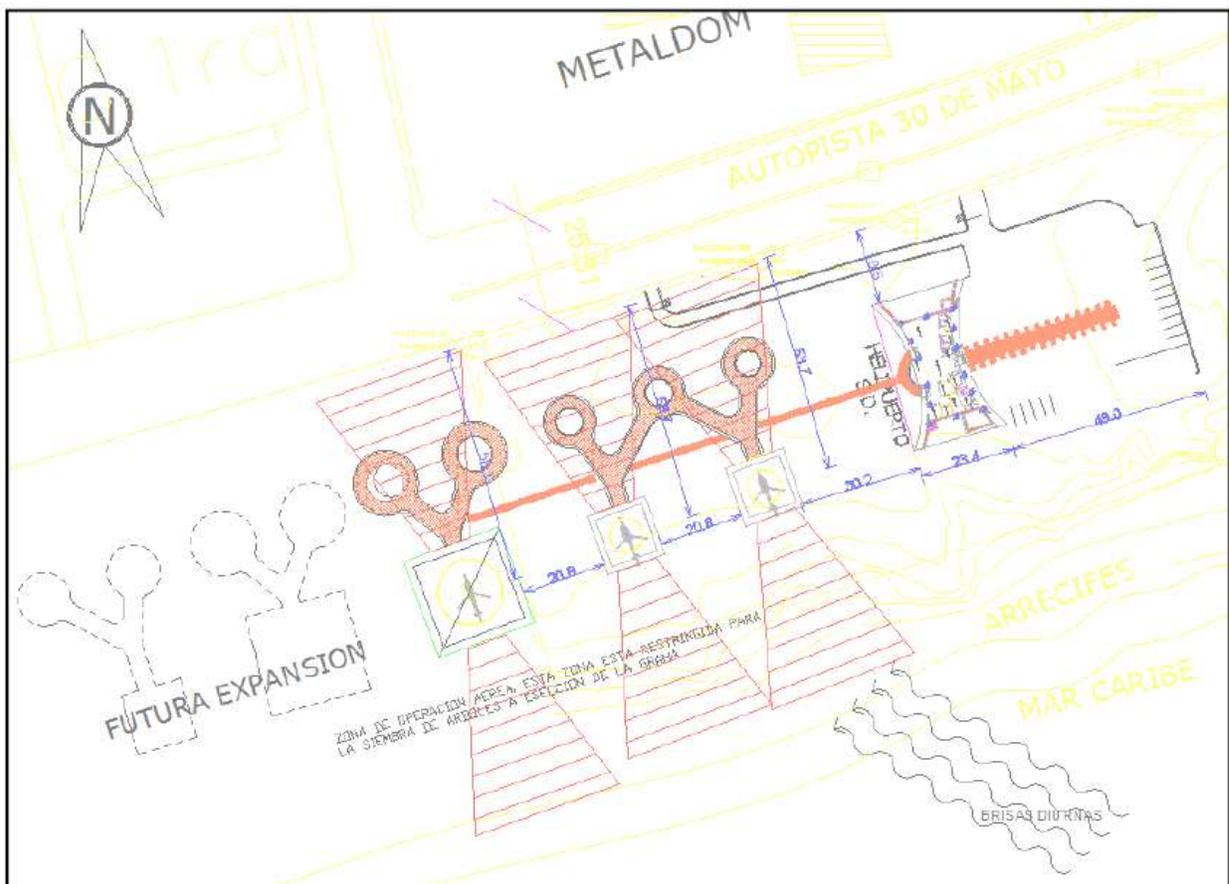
Planta general del proyecto. Plano suministrado por el cliente.
